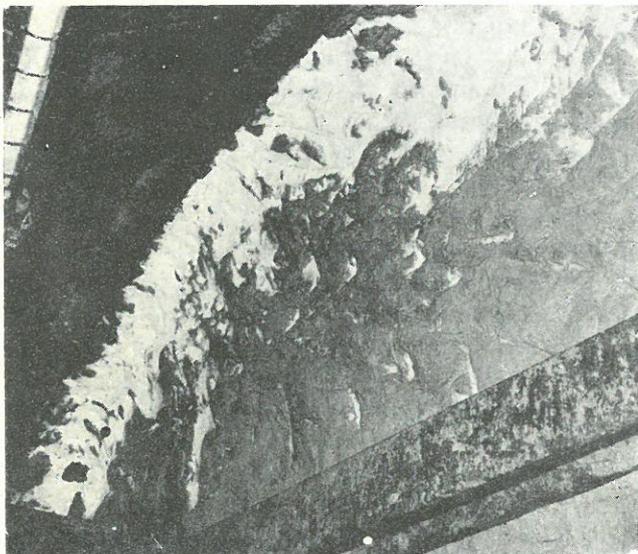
Galería de Sto. Marco. Terreno congelado en el frente de excavación.
